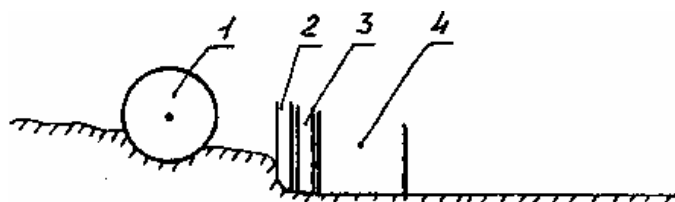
Схема расположения уплотняющего оборудования для асфальтоукладчиков фирмы «АБГ» (Германия):
